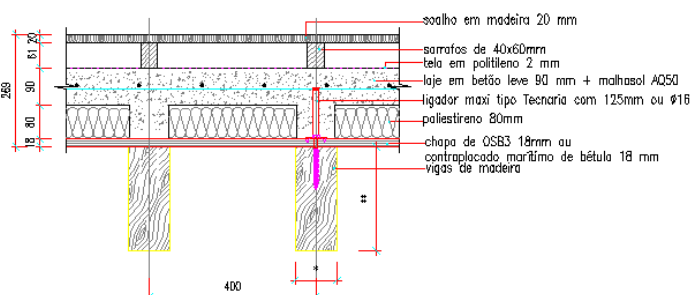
e 7 - Estrutura dos pavimentos em fase de obra. Detalhe dos pavimentos em estrutura mista
